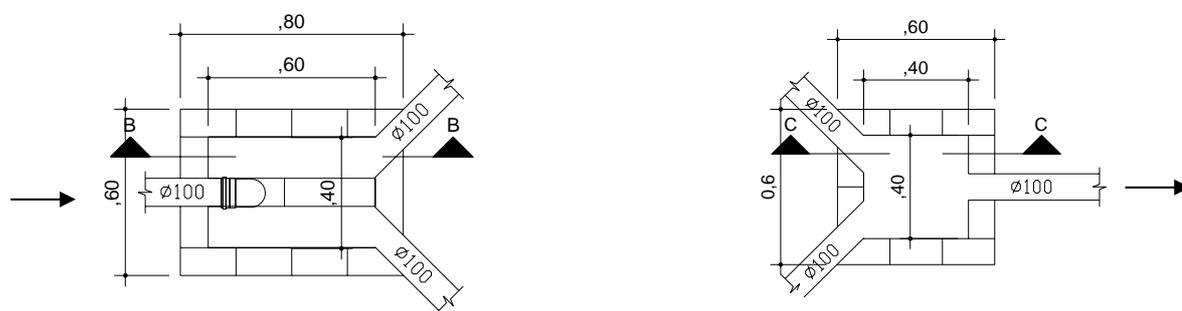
Planta baixa da primeira e segunda caixa de passagem do efluente. *Dimensões em metros (m).
